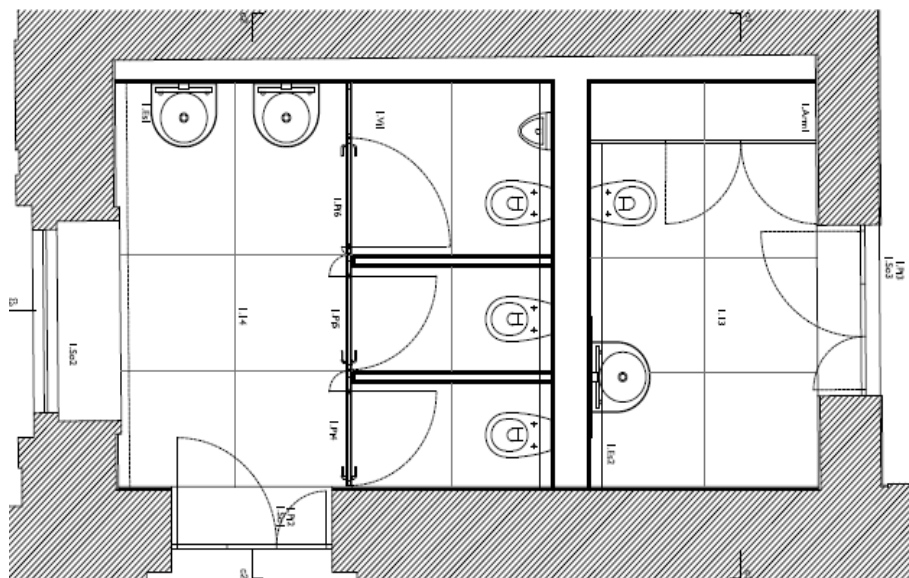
Planta, sem pormenorização, das instalações sanitárias 1.13 e 1.14
